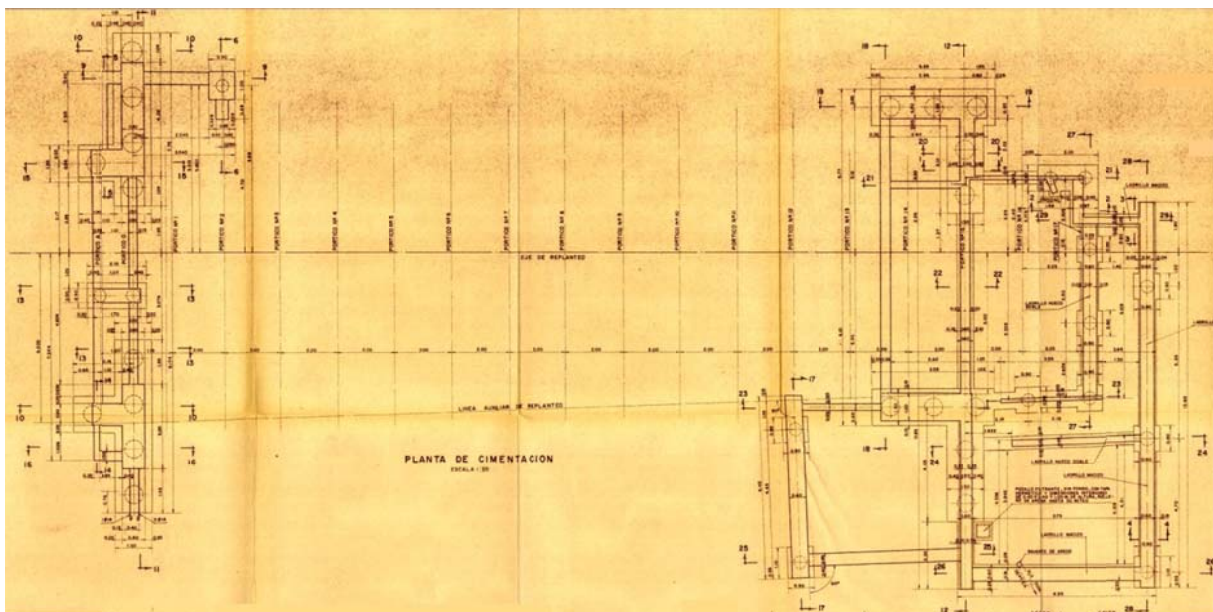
Plano de Cimentación por pilotes. (Nadal, J. 1960)
